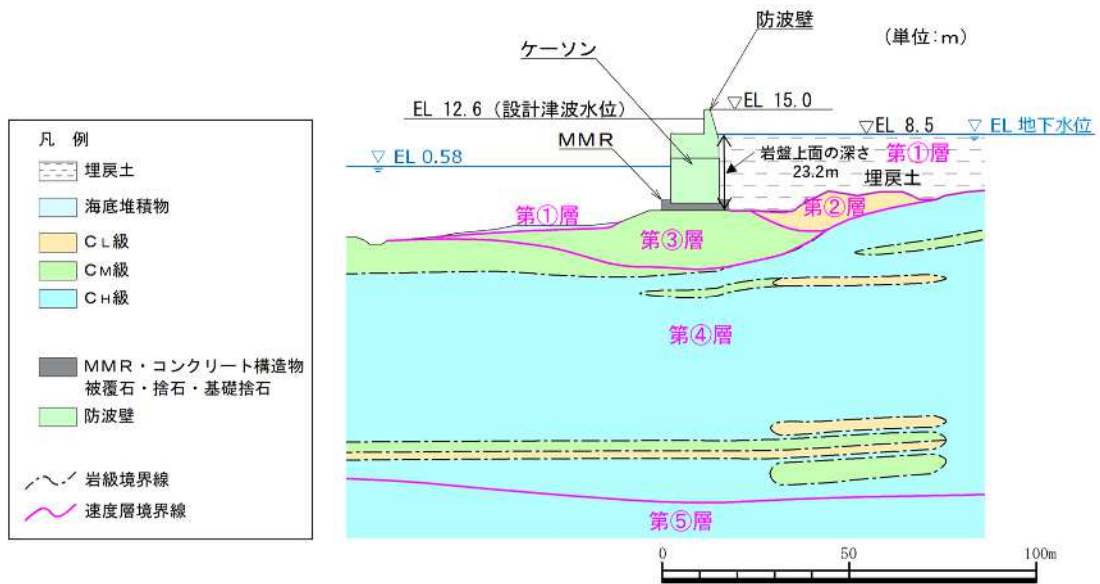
防波壁（波返重力擁壁）の横断面図
